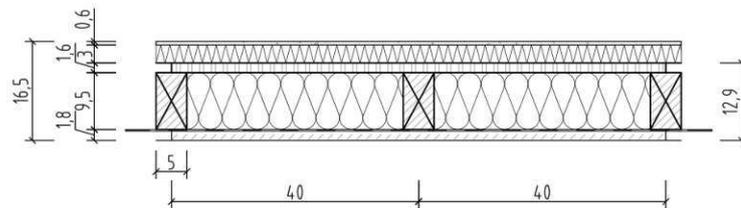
Außenwand Haus A (Quelle: eigene Darstellung)
